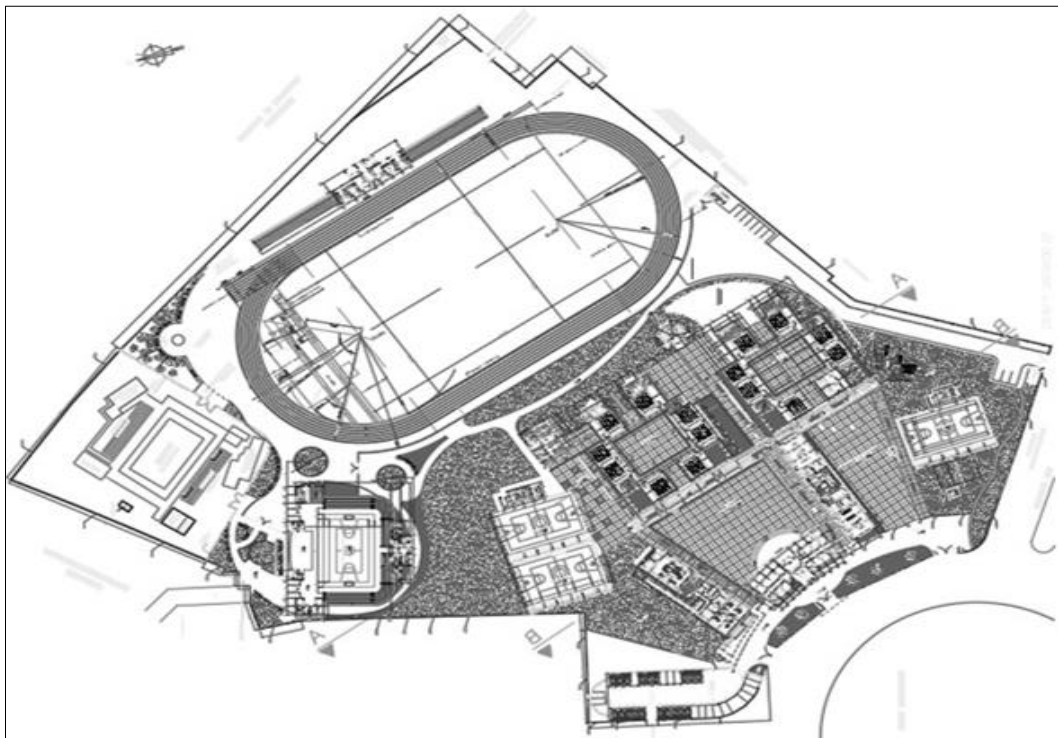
Plano de Planta General de la I.E. San Juan con la proyección de remodelación según el expediente técnico aprobado en el año 2015 – Región de la Libertad, obtenido del área Obras de la Adecuación, Mejoramiento y Sustitución de la Infraestructura – PRONIED.
